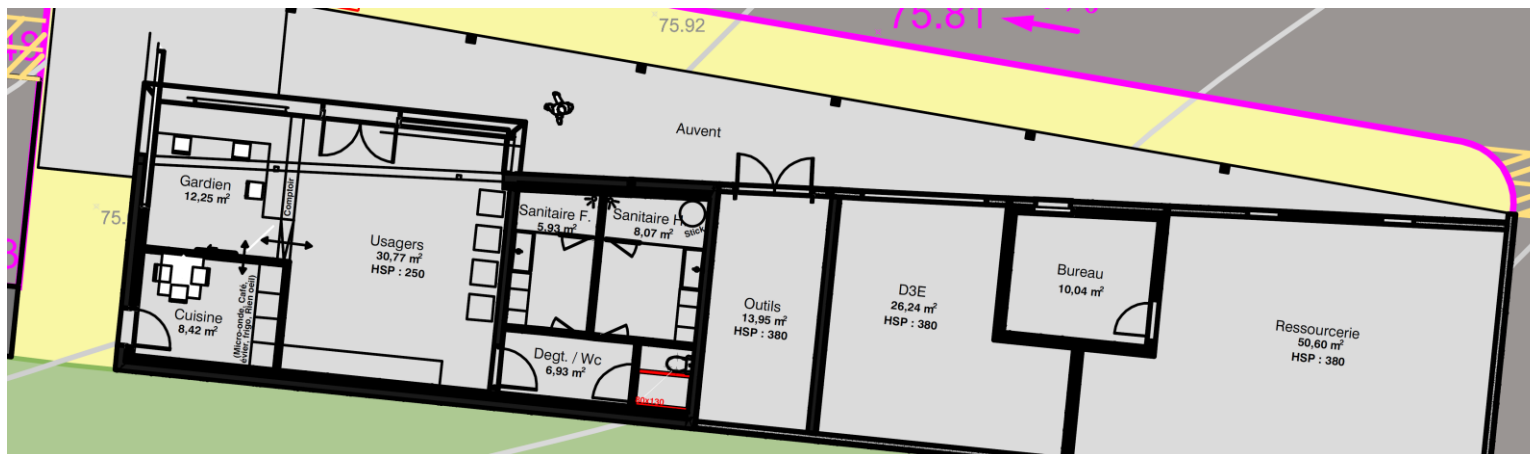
Bâtiment d'accueil (extrait du plan d'ensemble - source : AVP)
